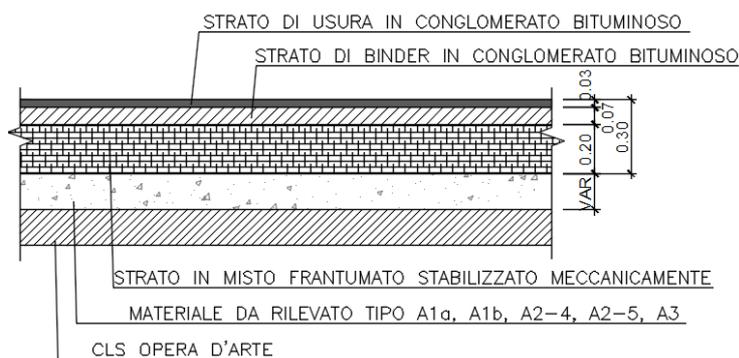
Pacchetto pavimentazione viabilità ciclopeditone
